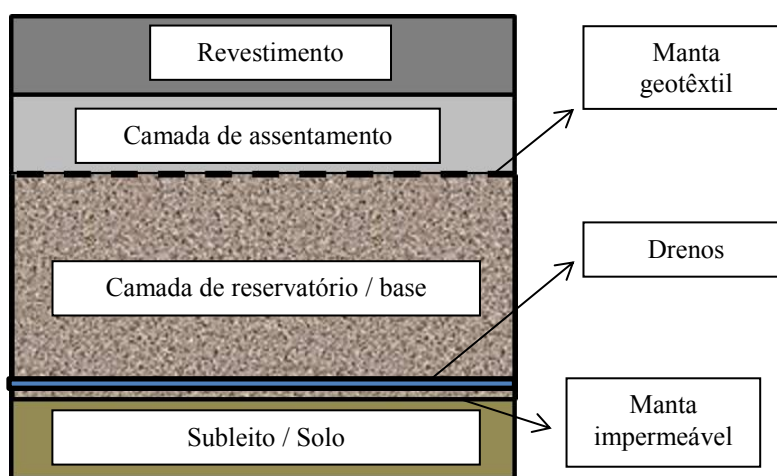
Perfil de pavimento permeável sem infiltração de água no subleito. Fonte: adaptado da ABNT (2015).
